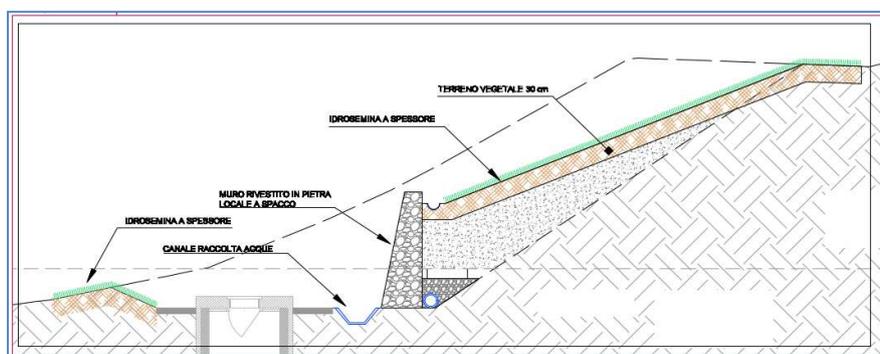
Inerbimento area lavorazione “pozzi drenanti” - sezione
